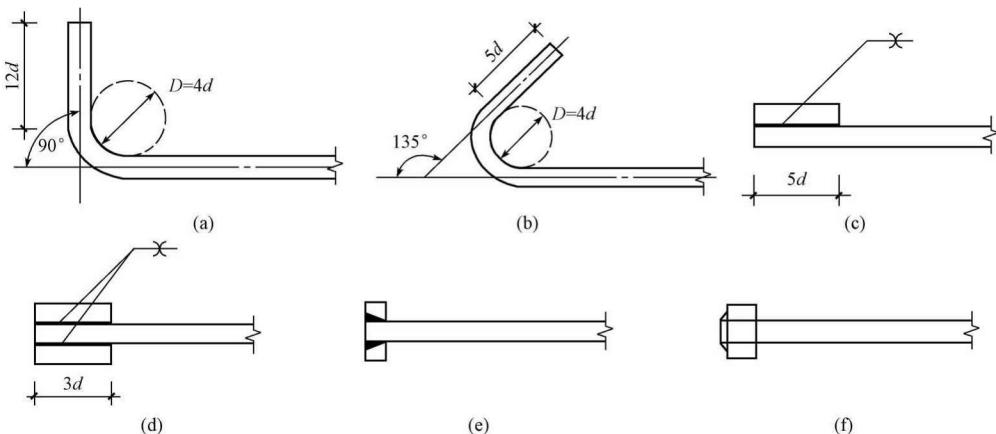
钢筋弯钩和机械锚固的形式和技术要求
